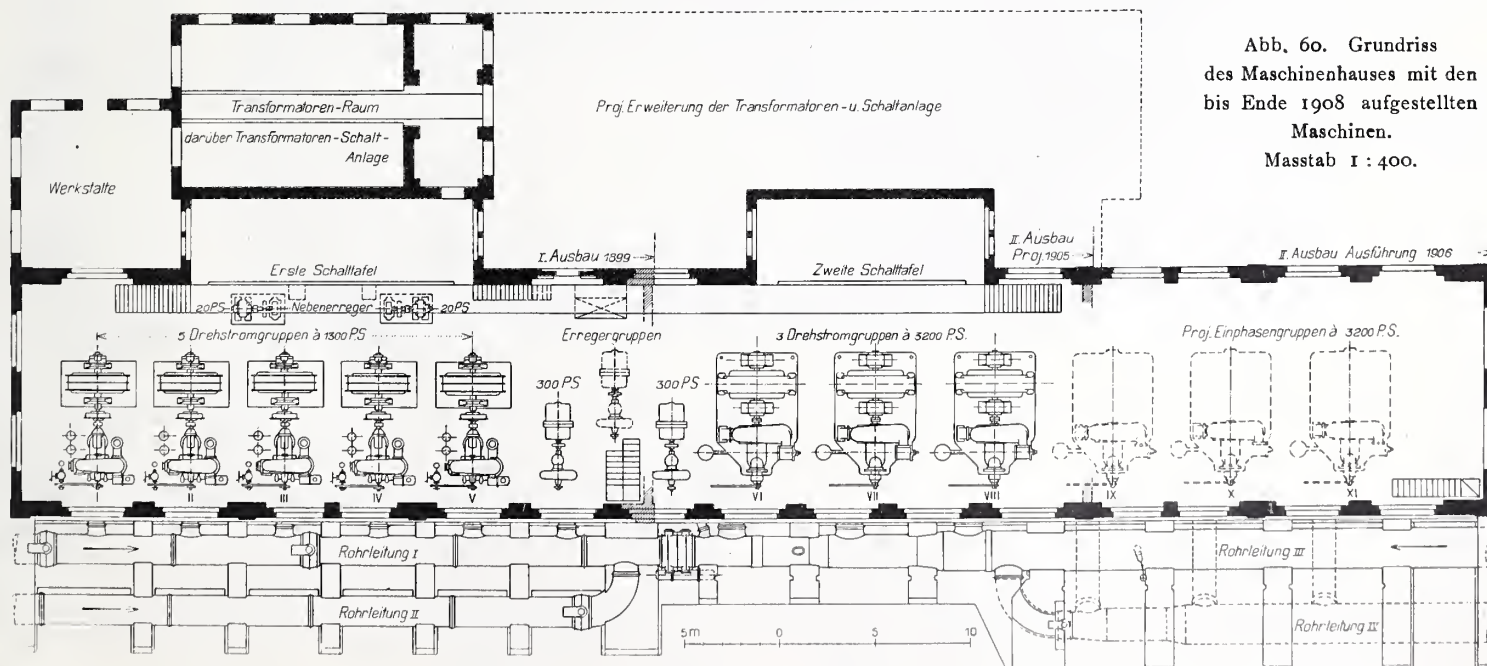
Grundriss des Maschinenhauses mit den bis Ende 1908 aufgestellten Maschinen.
